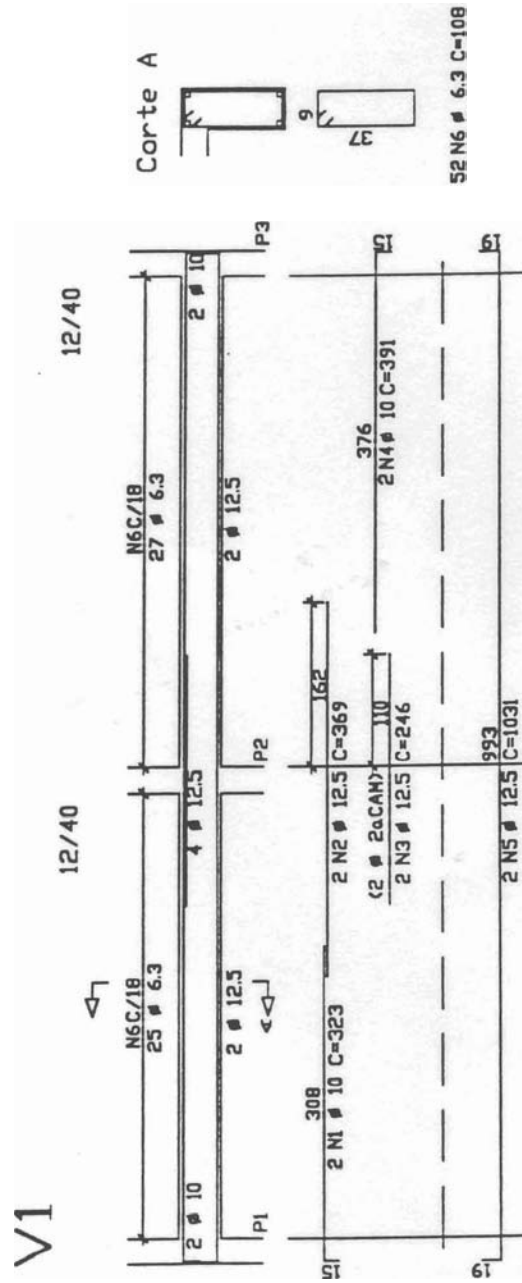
Detalhe de armadura da viga V1 (viga continua)
